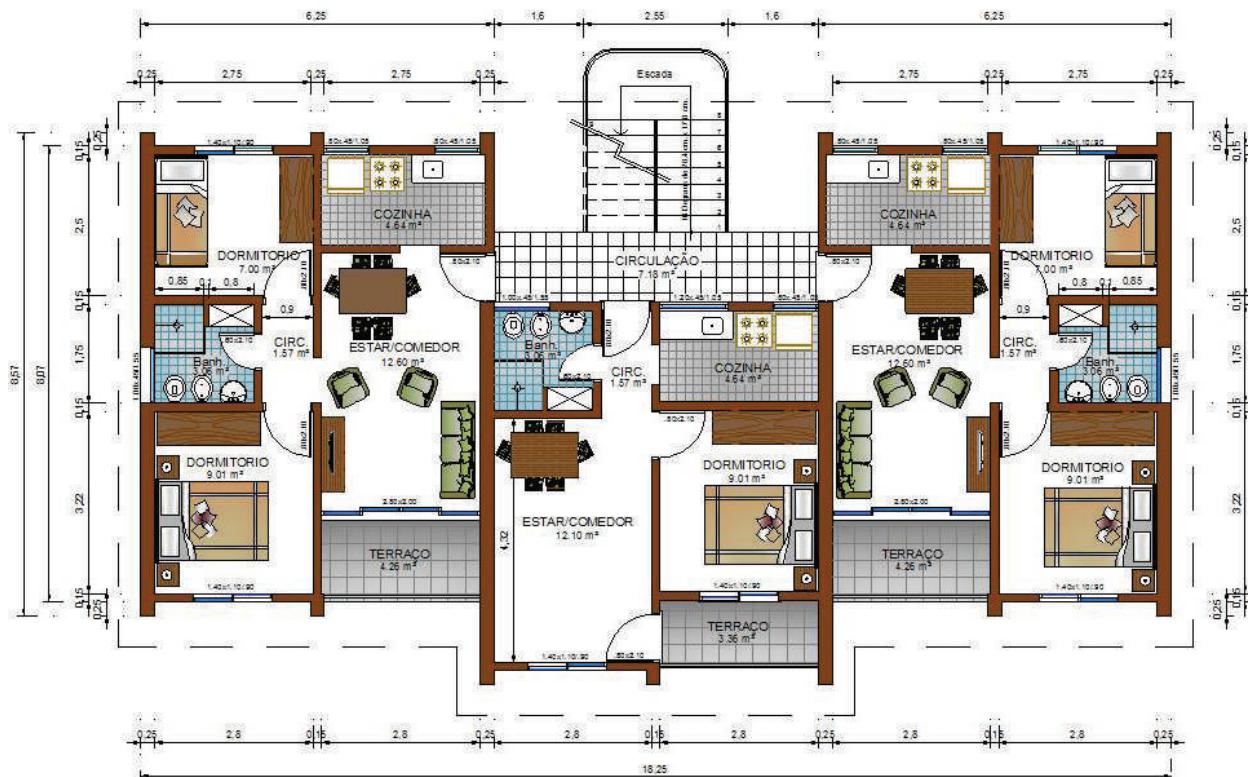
Planta Baixa do bloco com 6 apartamentos, 3 por andar. Nota-se que, no projeto, existe uma intenção clara de sua adaptação a esse sistema de abóbodas. (*-5).
